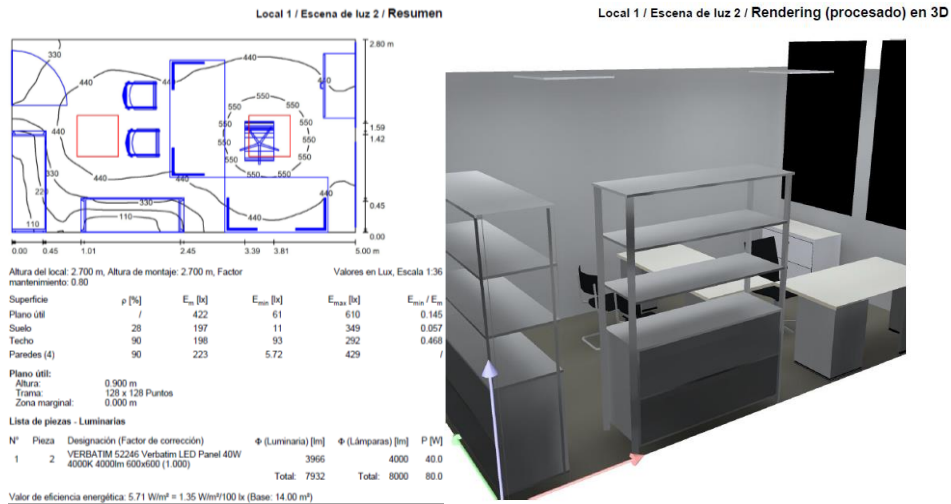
Diseño de iluminación propuesto para despacho en Planta 6.
